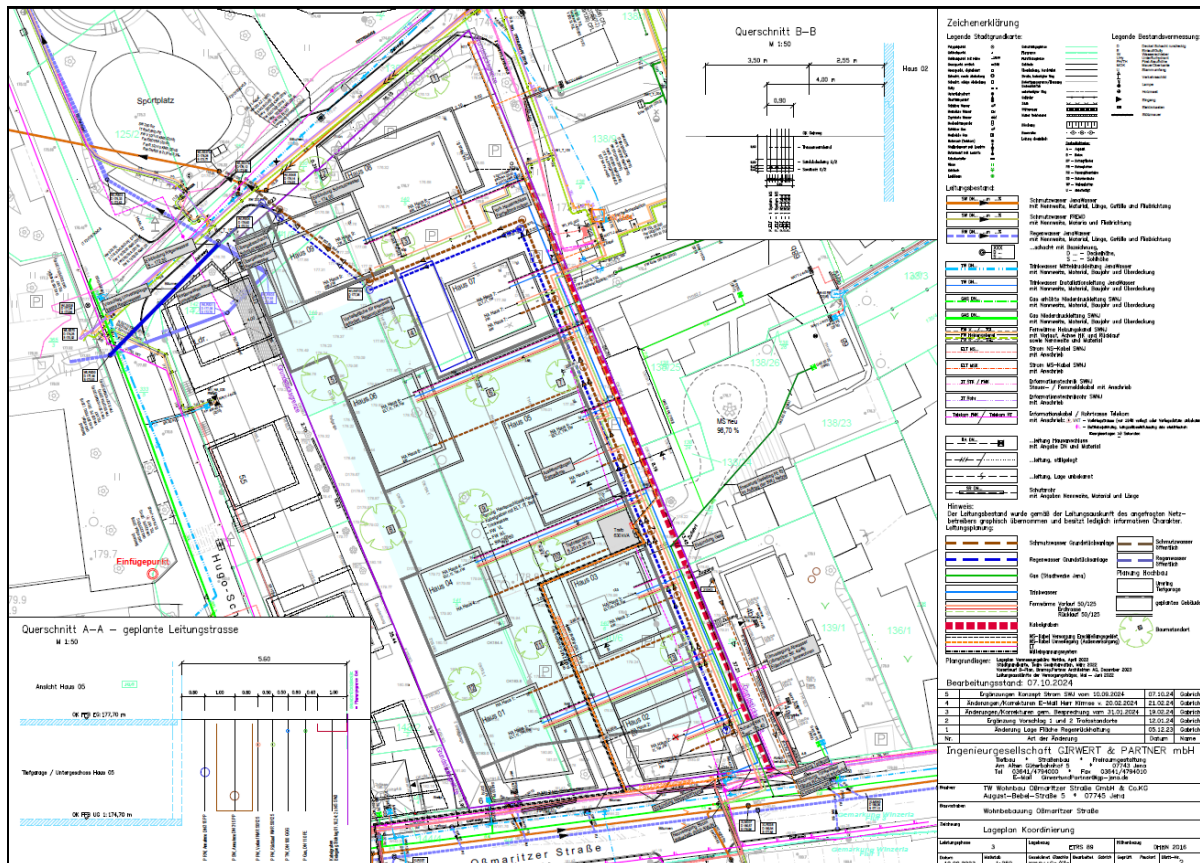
Grundzüge der koordinierten Leitungsführung an der östlichen Grundstücksgrenze
